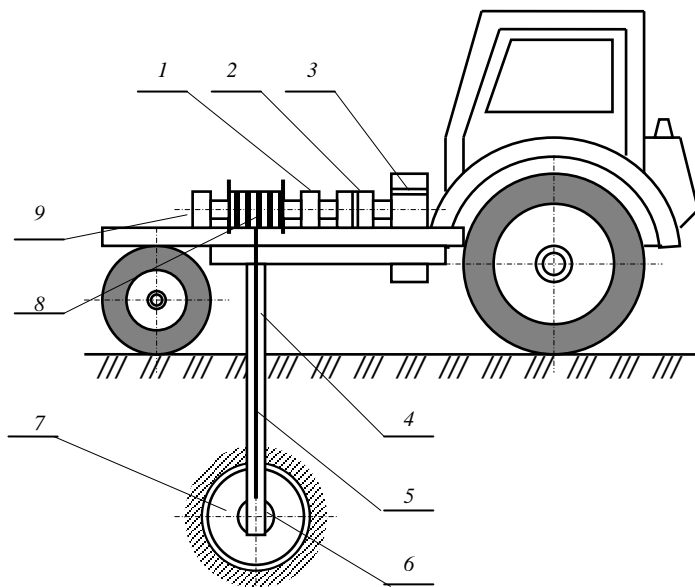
Машина для очистки труб-переездов: 1, 9 – опоры; 2 – муфта; 3 – редуктор; 4 – штанги; 5 – канат; 6 – полукольца; 7 – рабочий орган; 8 – барабаны
